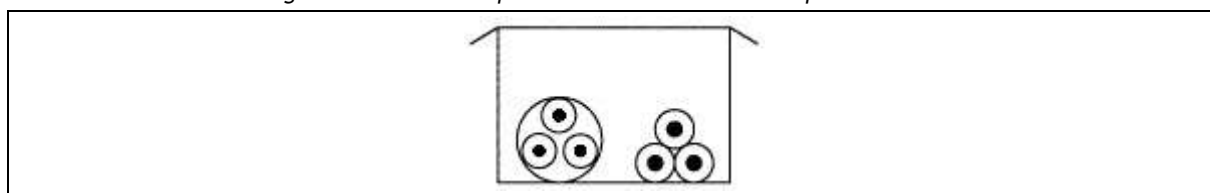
Modes de pose des canalisations électriques – Conduits dans caniveaux fermés
